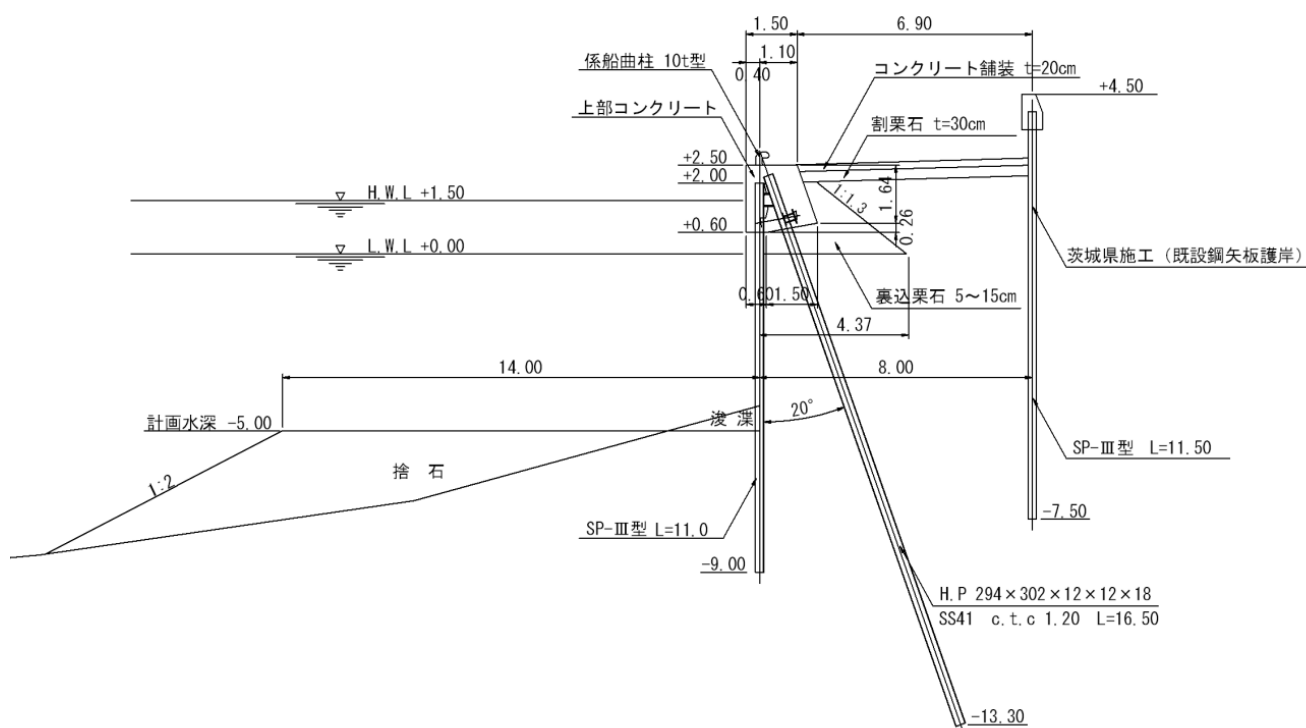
No.5 池向岸壁の標準断面図 (被災前)
